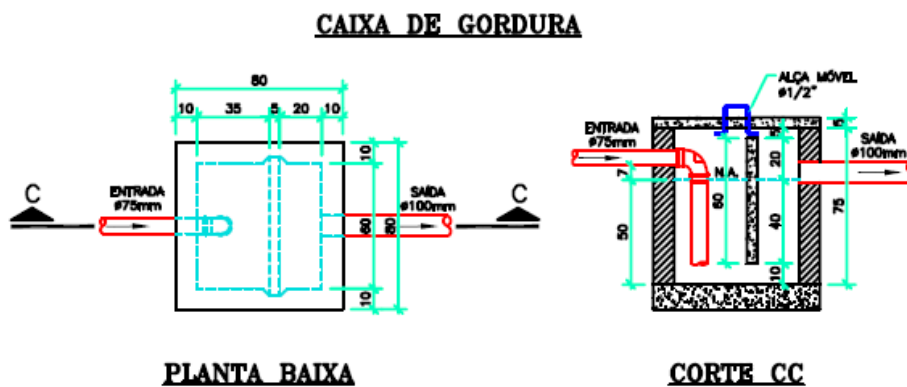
Plantas dos sistemas a serem implantados na ETC.
